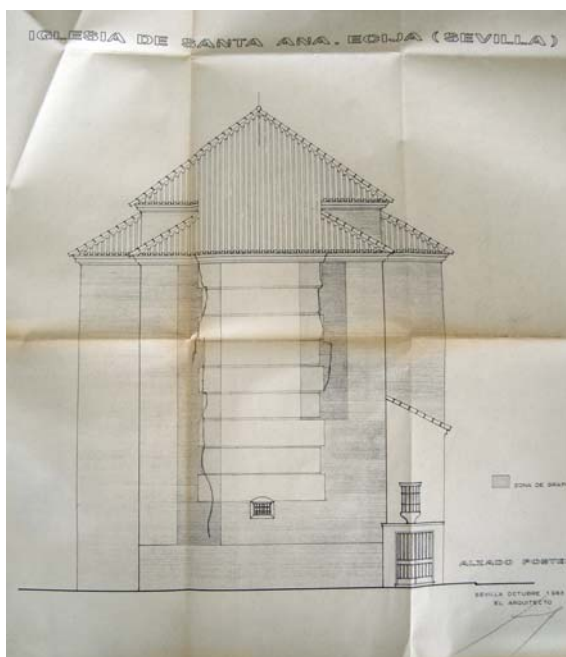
Imagen extraída del proyecto en la que se definen las fisuras en la fachada de la Iglesia de Santa Ana en Écija.
